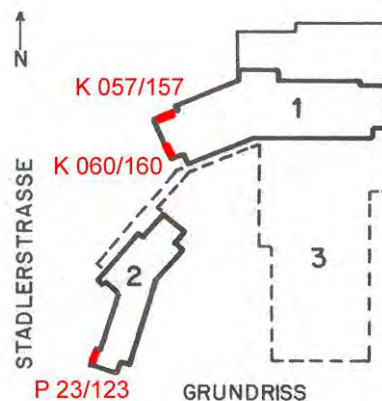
Überprüfte Befestigungs- und Rückhalteelemente
